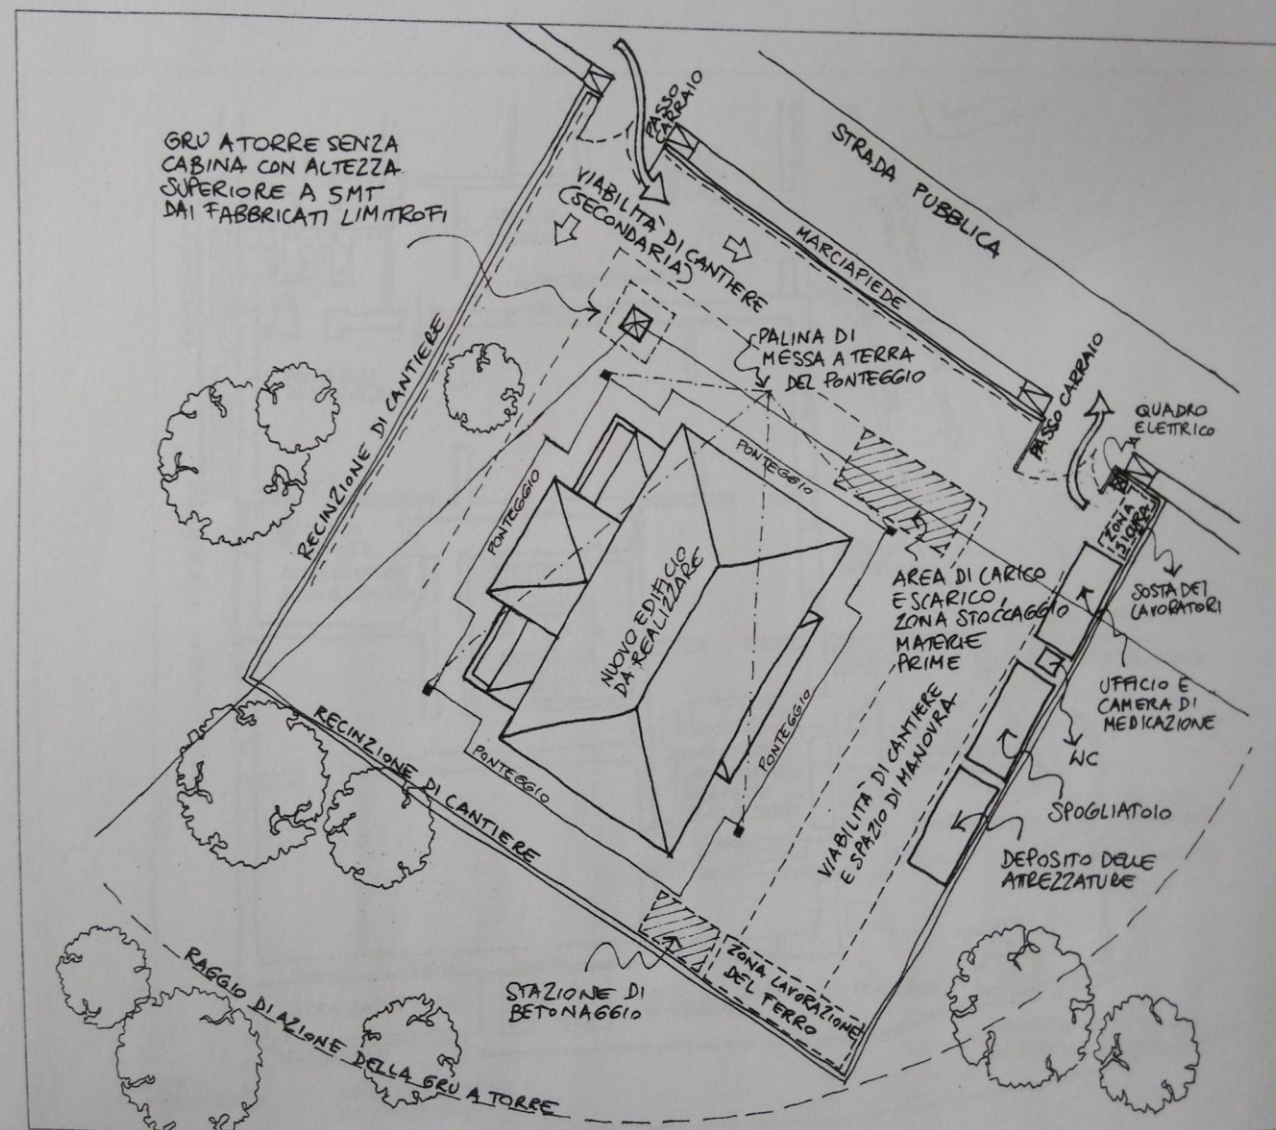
Esempio di cantiere di nuova costruzione in area isolata.
